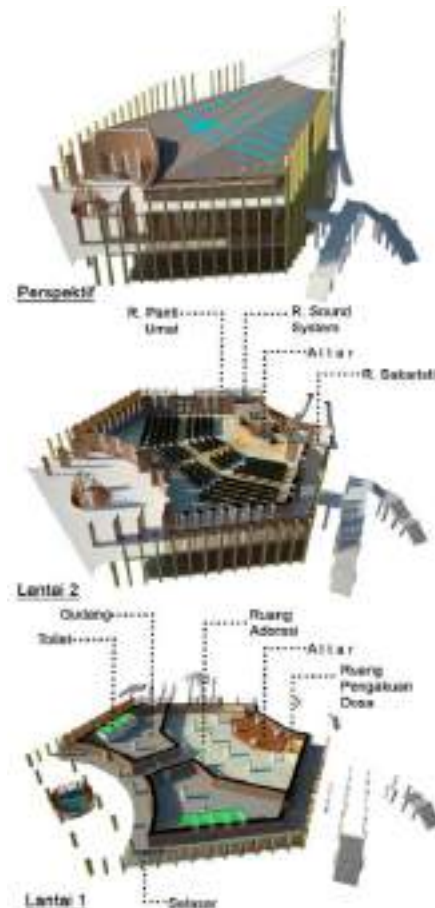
26 pendekatan ekologi pada bangunan
